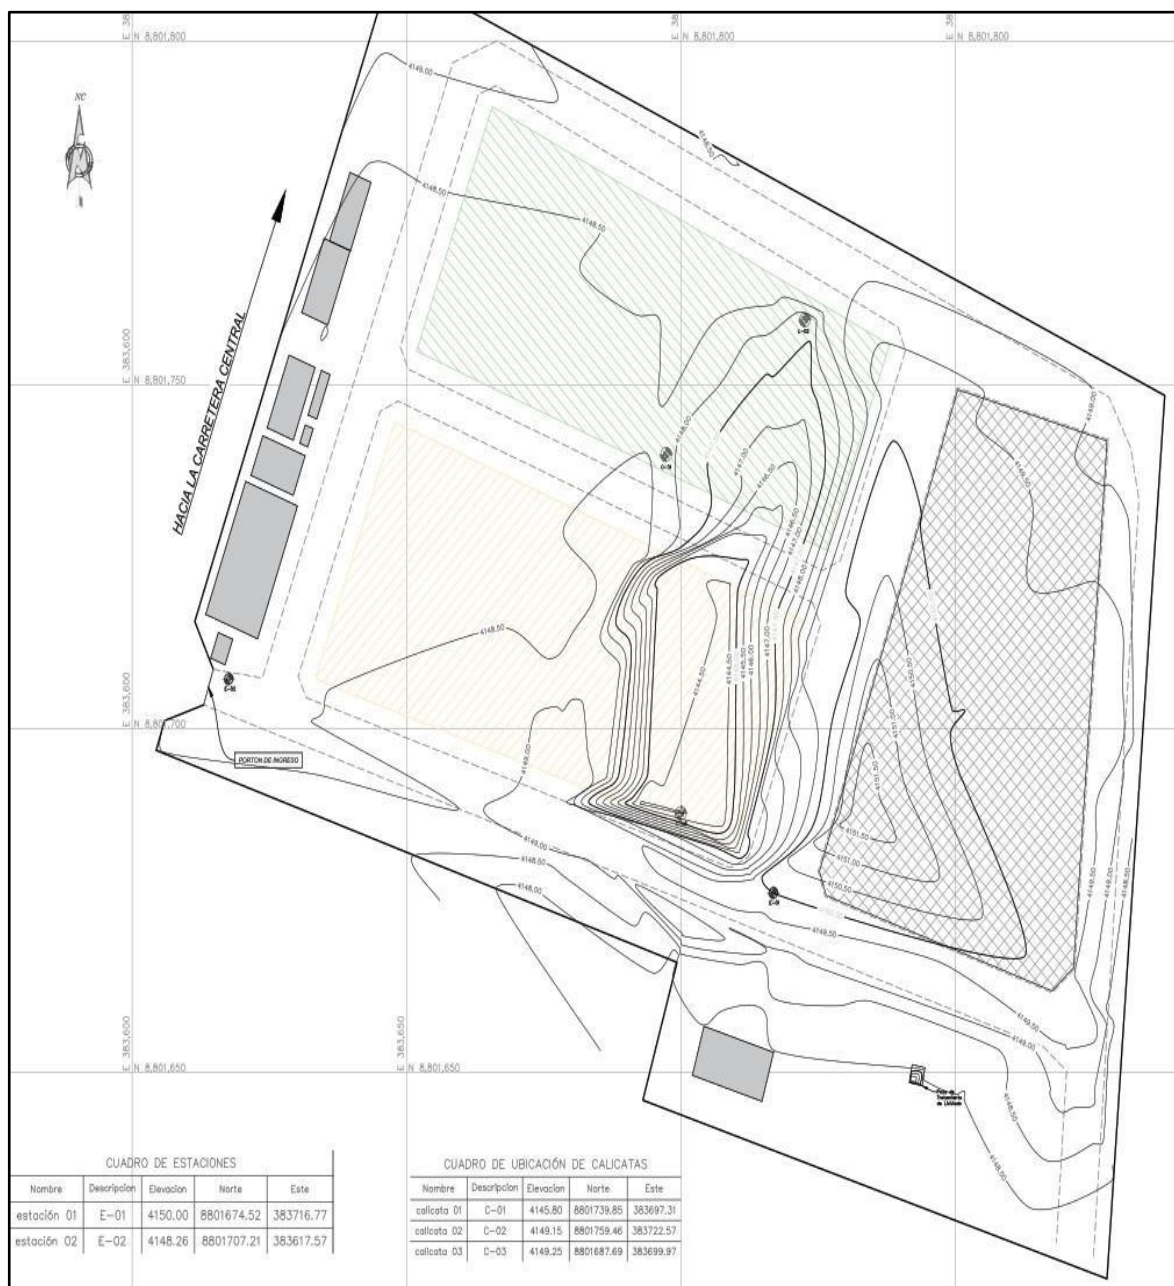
Vista del Proyecto antes de su ejecucion
